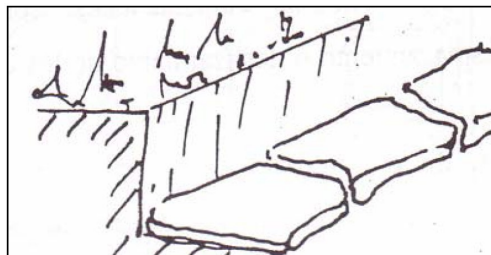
Enlosado del Fondo de la Cimentación Según Palladio
